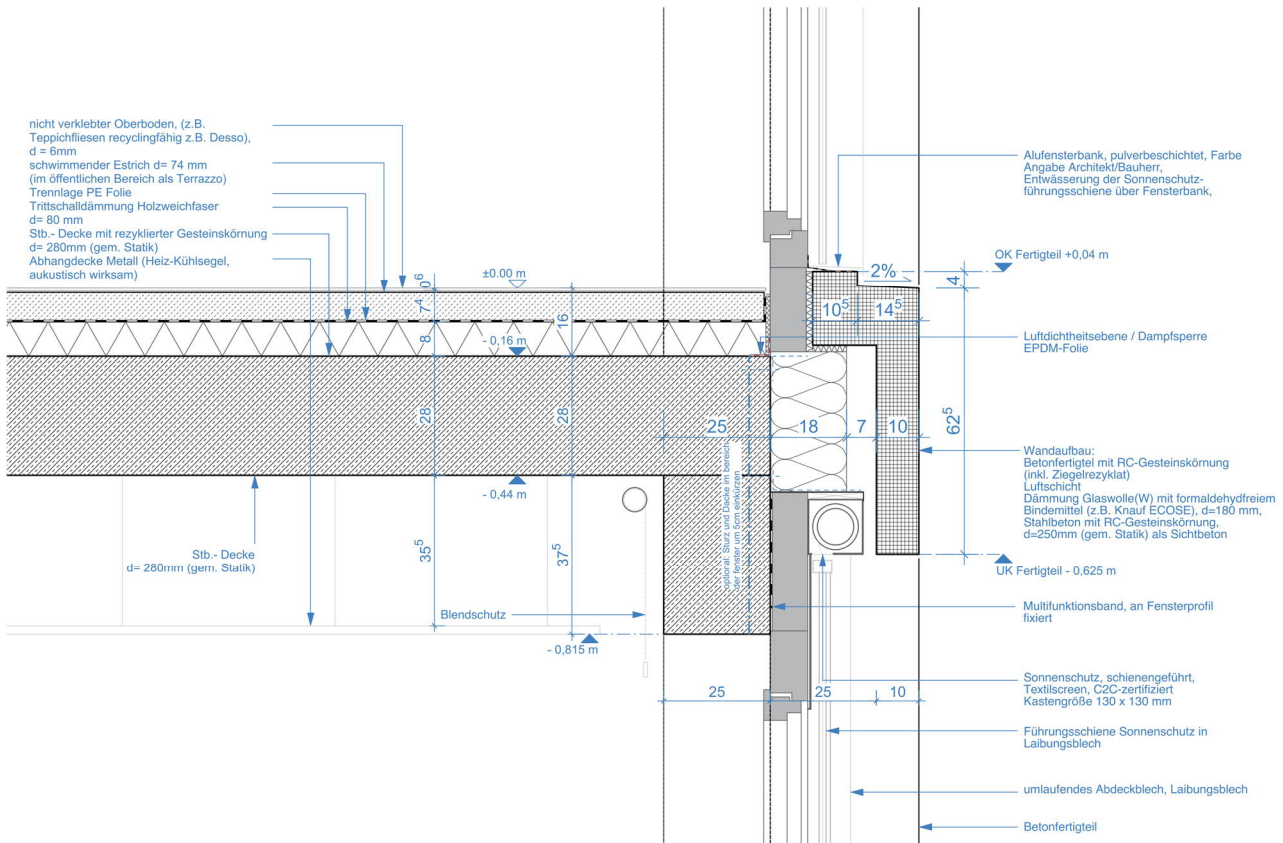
Leitdetail Geschosdecke/Fassade_optimierte Planung
